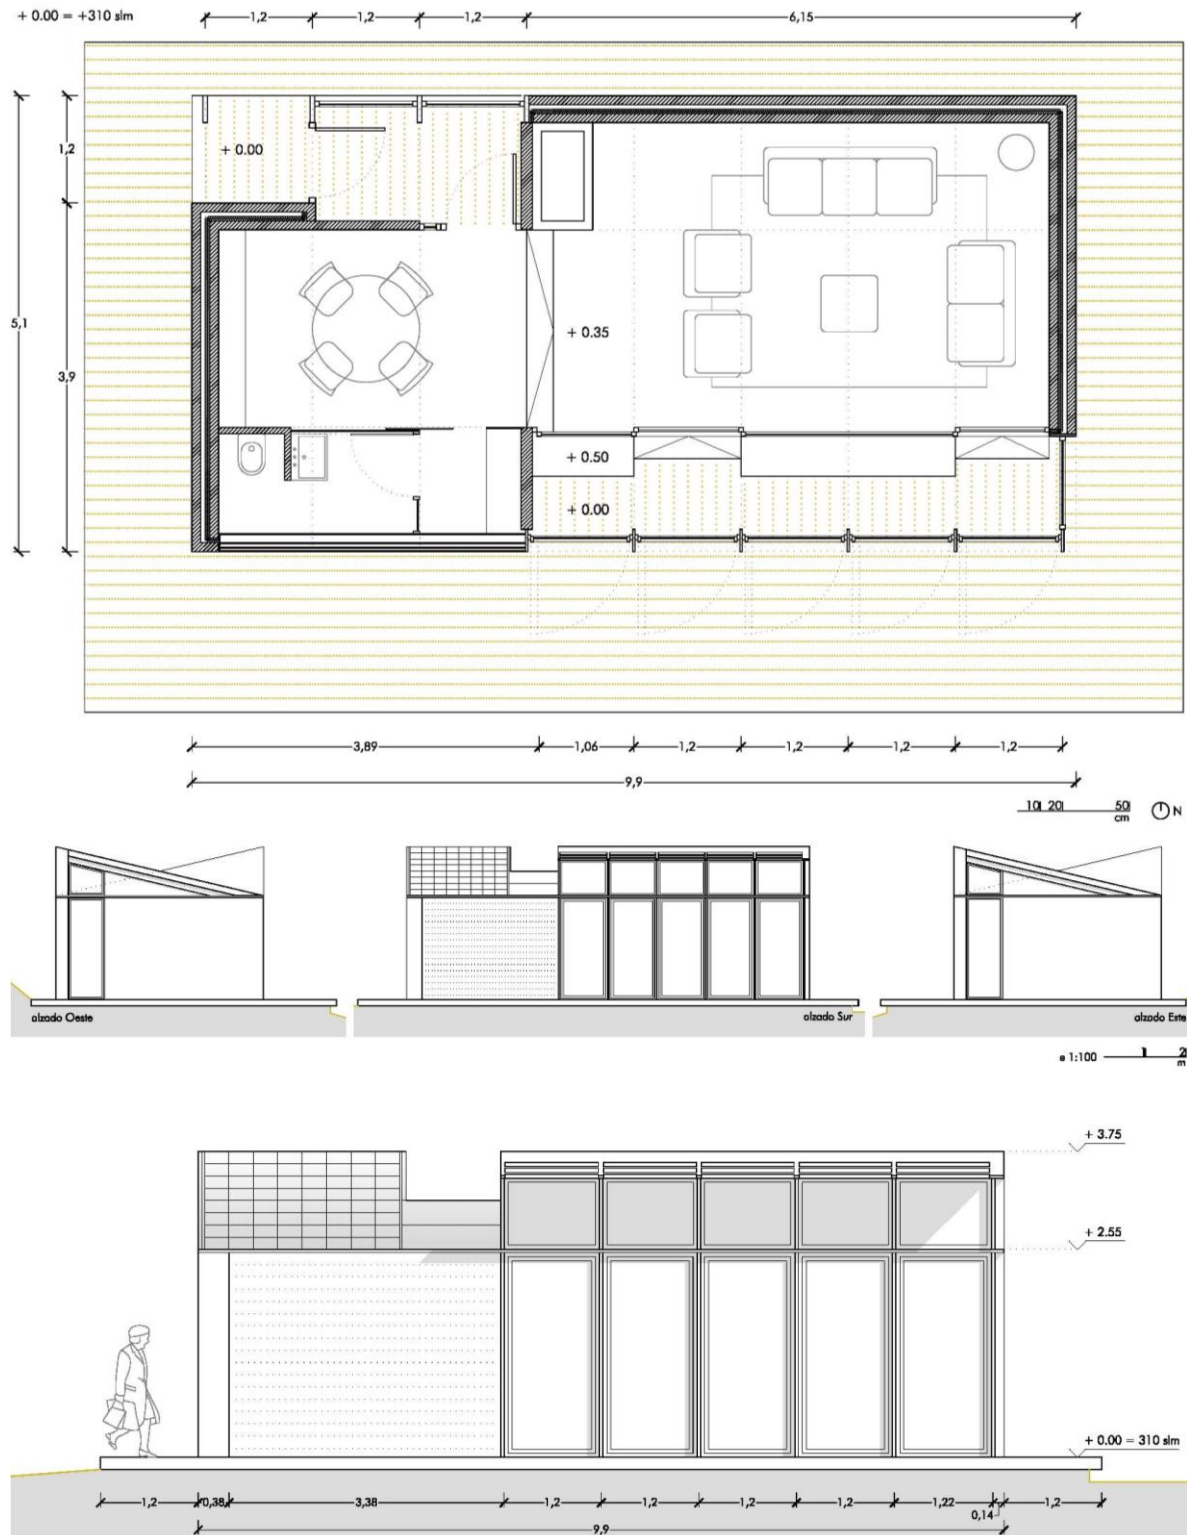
Planta principal del Pabellón y sus alzados. En grande la fachada sur donde se pondrán los sistemas captadores
